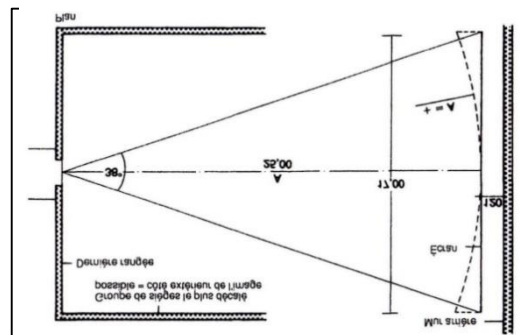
plan d'une salle de cinéma -source : Neufert 10eme édition
